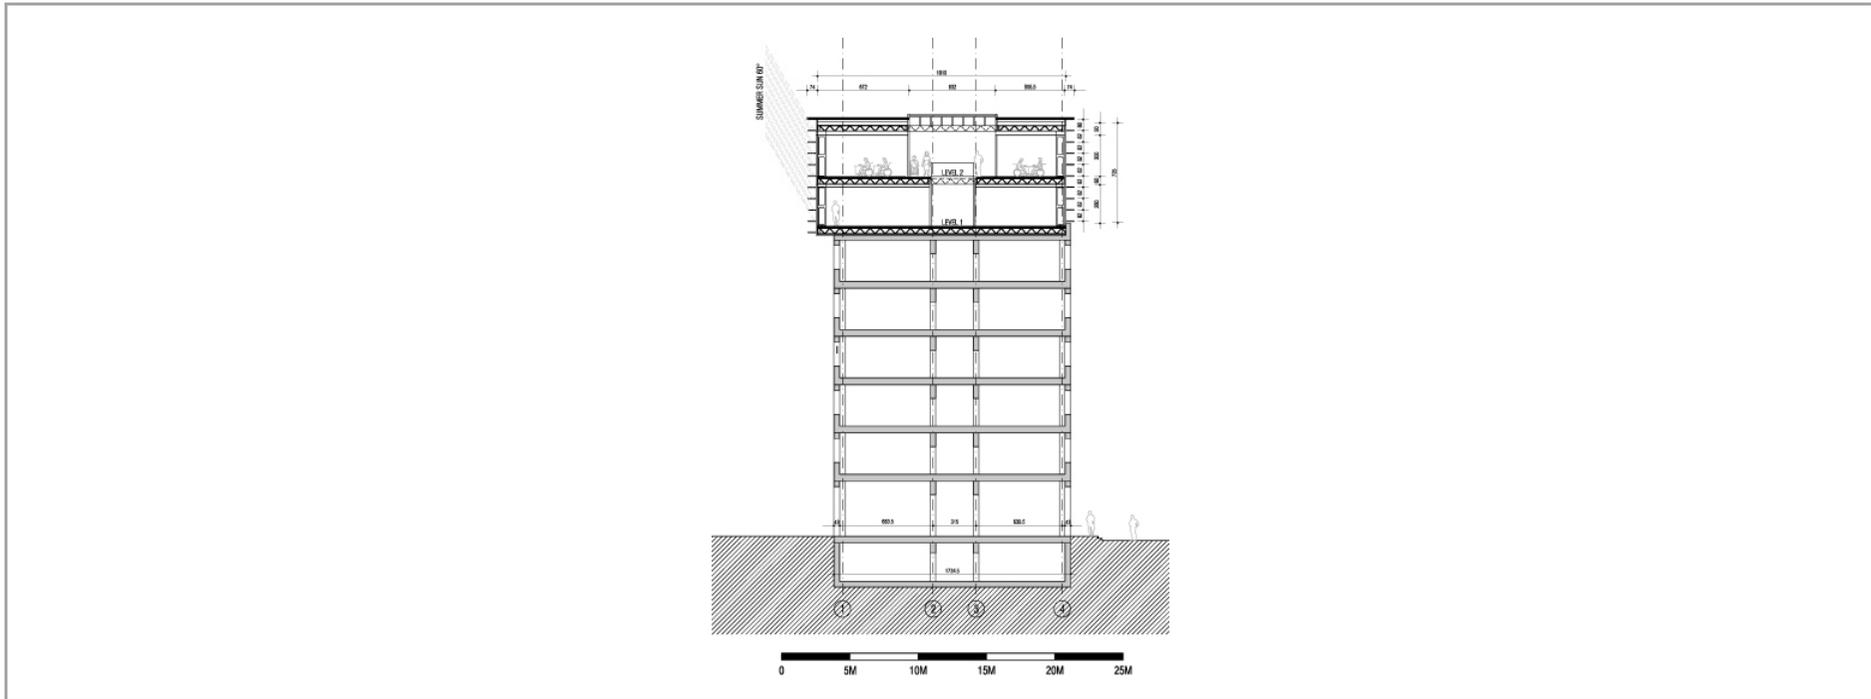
Dachaufbau Schneider – Ebene 1 (Key Station der TU Wien, 2008)
